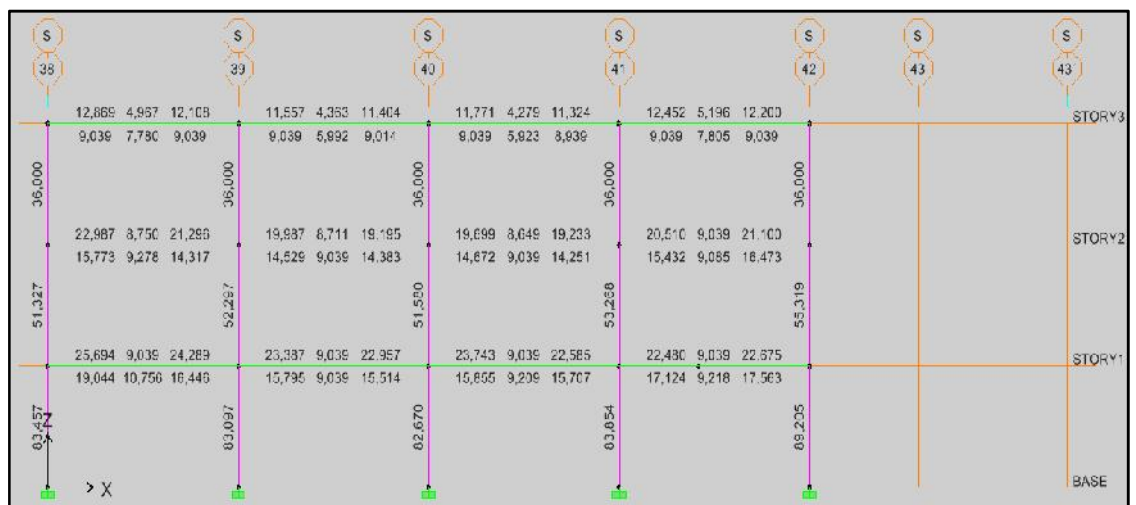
Acero en vigas pórtico S, Consulta Externa I
